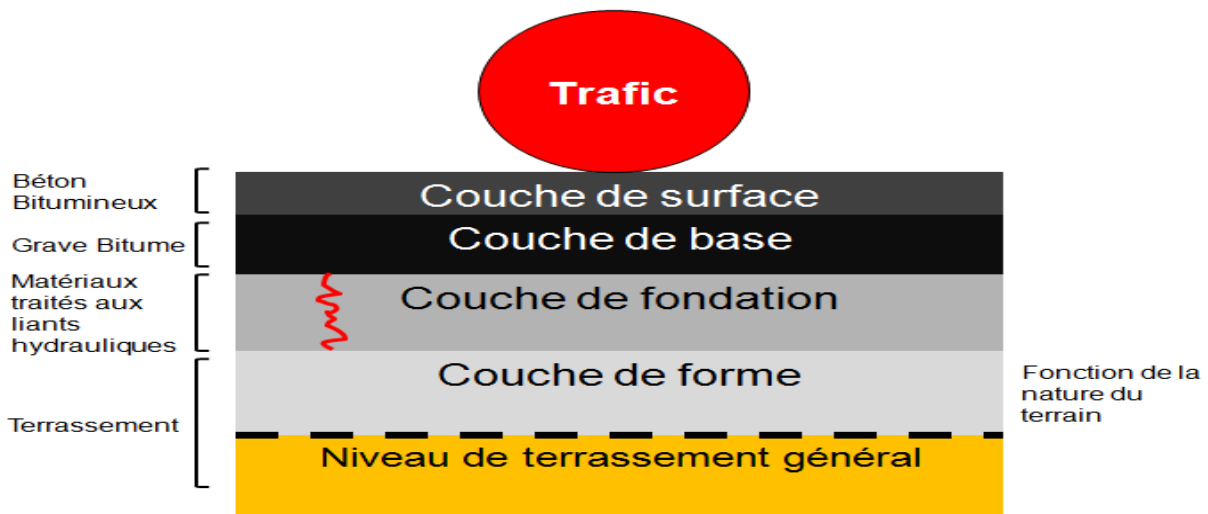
Les couches d'une chaussée à structure mixte [2].
